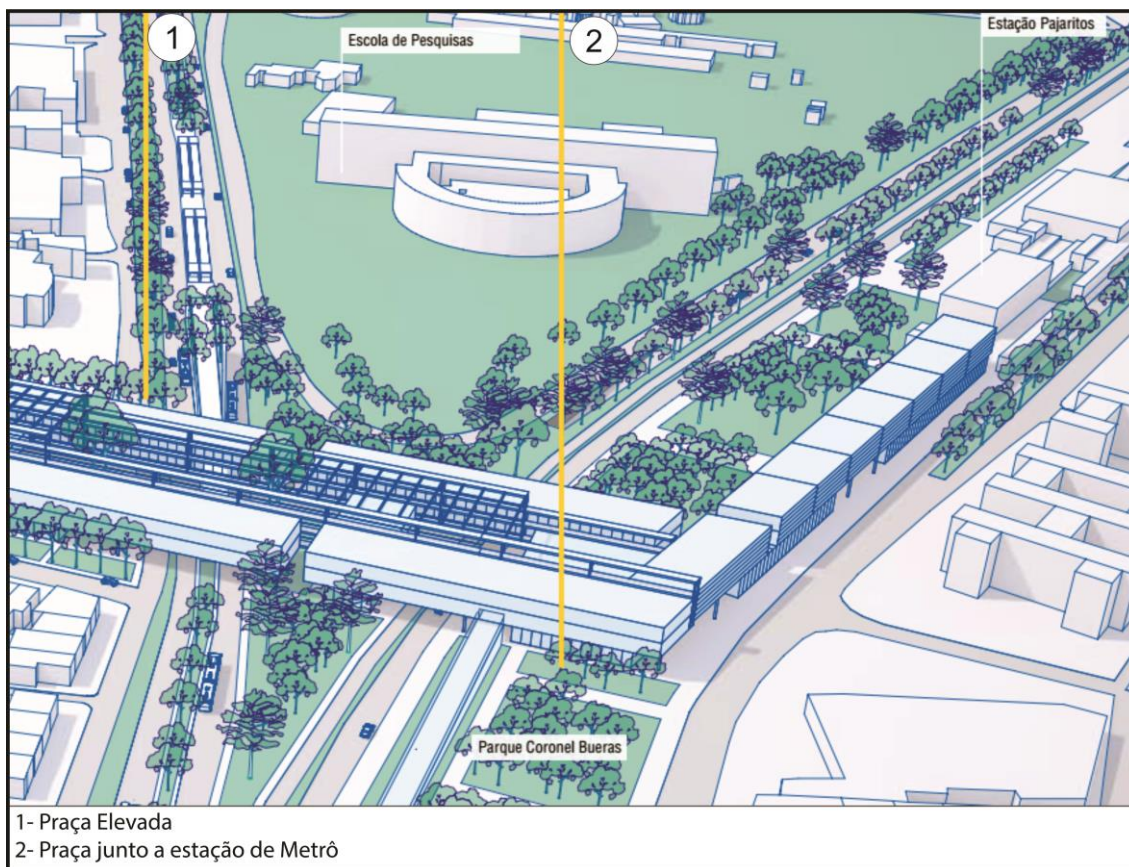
Proposta praça elevada Eixo Alameda Providencia.
